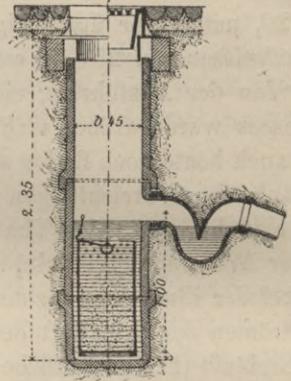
zeigt einen Einlauf aus Cementbeton von der Form, wie er in Danzig und in etwas veränderter Art in Breslau und Königsberg zur Verwendung gelangte; der Wasserverschluss wird durch ein nach oben gebogenes Knierohr gebildet, welches am besten aus Eisen hergestellt wird. — Fig. 146 und 147 stellen zwei Einläufe aus gebranntem Thon dar, von denen Fig. 146 in London, Fig. 147 in Frankfurt häufig ausgeführt ist. Der Frankfurter Einlauf hat eine gröfsere, gegen Frost besser schützende Tiefe; auch ist durch die Art der Abdeckung dafür gesorgt, daß eine Verschiebung des Gitters gegen die Strafsenrinne möglich ist und daß der Raddruck nicht unmittelbar das obere Thonrohr trifft, daß ferner der durch Vermittelung eines Trichters erfolgende Zufuß in den Schlammeimer gelangt, wo die Sinkstoffe abgesetzt werden. Derartige Eimer erleichtern die Entfernung des Schlammes wesentlich; das Herausnehmen durch Baggerschaufeln ist umständlicher und weniger reinlich. Doch wird der Schlamm bei starkem Zulauf leicht in den Raum zwischen Einlaufwand und Eimer gespült, wodurch die Herausnahme des letzteren erschwert und die nachträgliche Beseitigung des zurückgebliebenen Restes erforderlich wird. Geiger gestaltet deshalb (D. R. P. 38210) den oberen Rand des Eimers konisch (Fig. 148) und lagert diesen auf einen ebenfalls konischen, an die aus gebranntem Thon, Cementbeton oder Gufseisen hergestellte Einlaufwand anschließenden Ring aus Gufseisen, sodafs der Eimer hängt und kein Schmutz in den oben erwähnten Zwischenraum gelangen kann. Die Entleerung des Eimers erfolgt durch den zum Aufklappen eingerichteten Boden in den Schlammwagen (welcher bei der von Geiger ausge-
